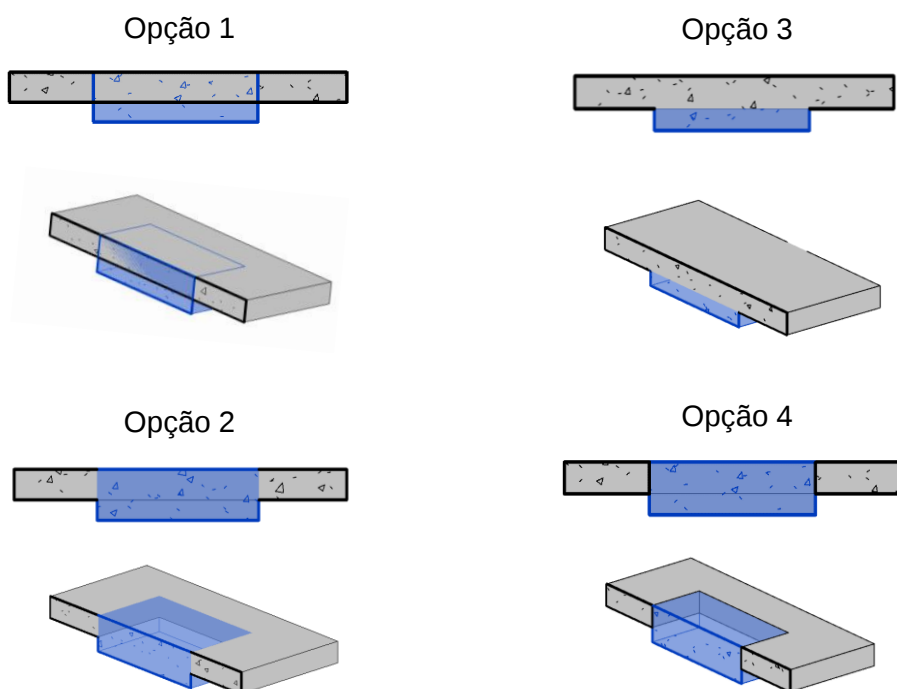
Opções de modelação para lajes, bandas e capitéis
